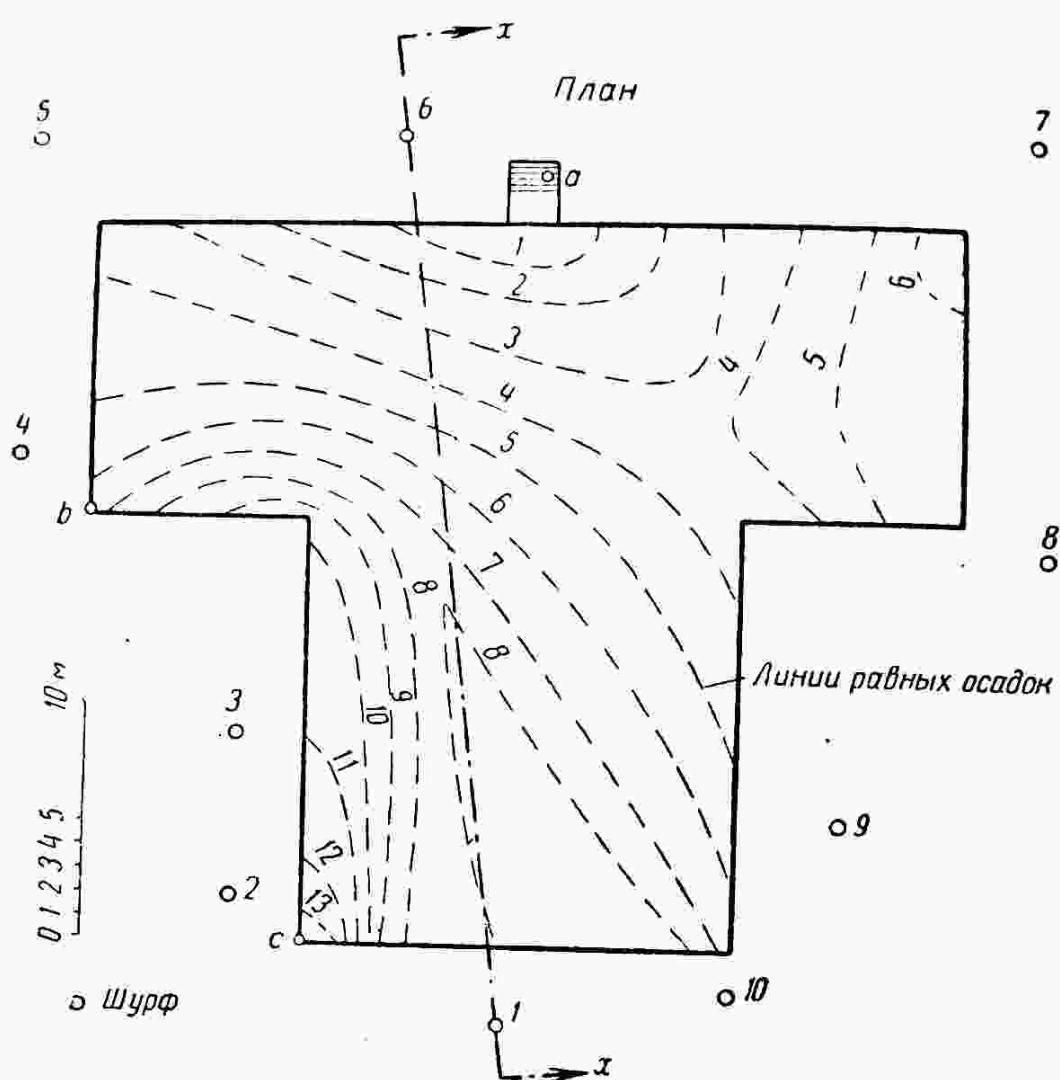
Напластование грунтов под иодной водолечебницей в Пештэржебете
